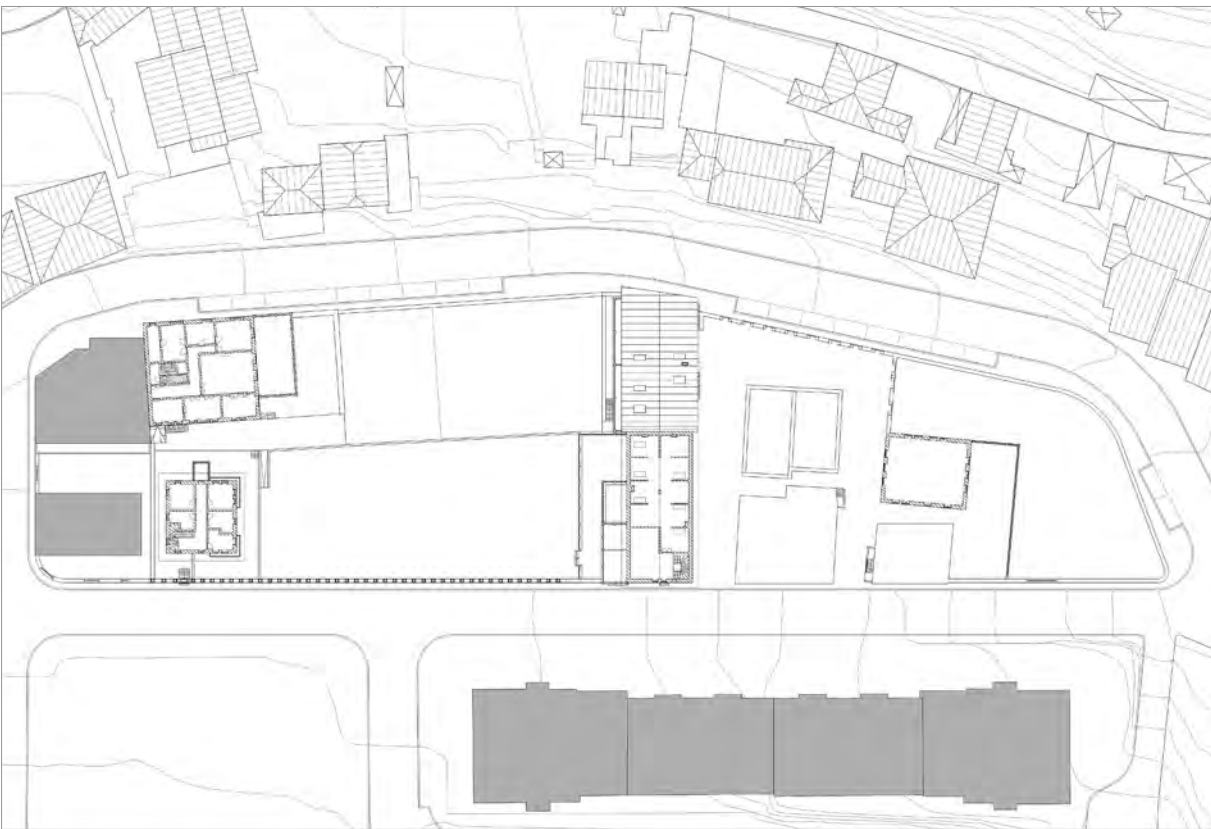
Planta de levantamento do Bairro Ricardo Mota, à cota 688.2.
